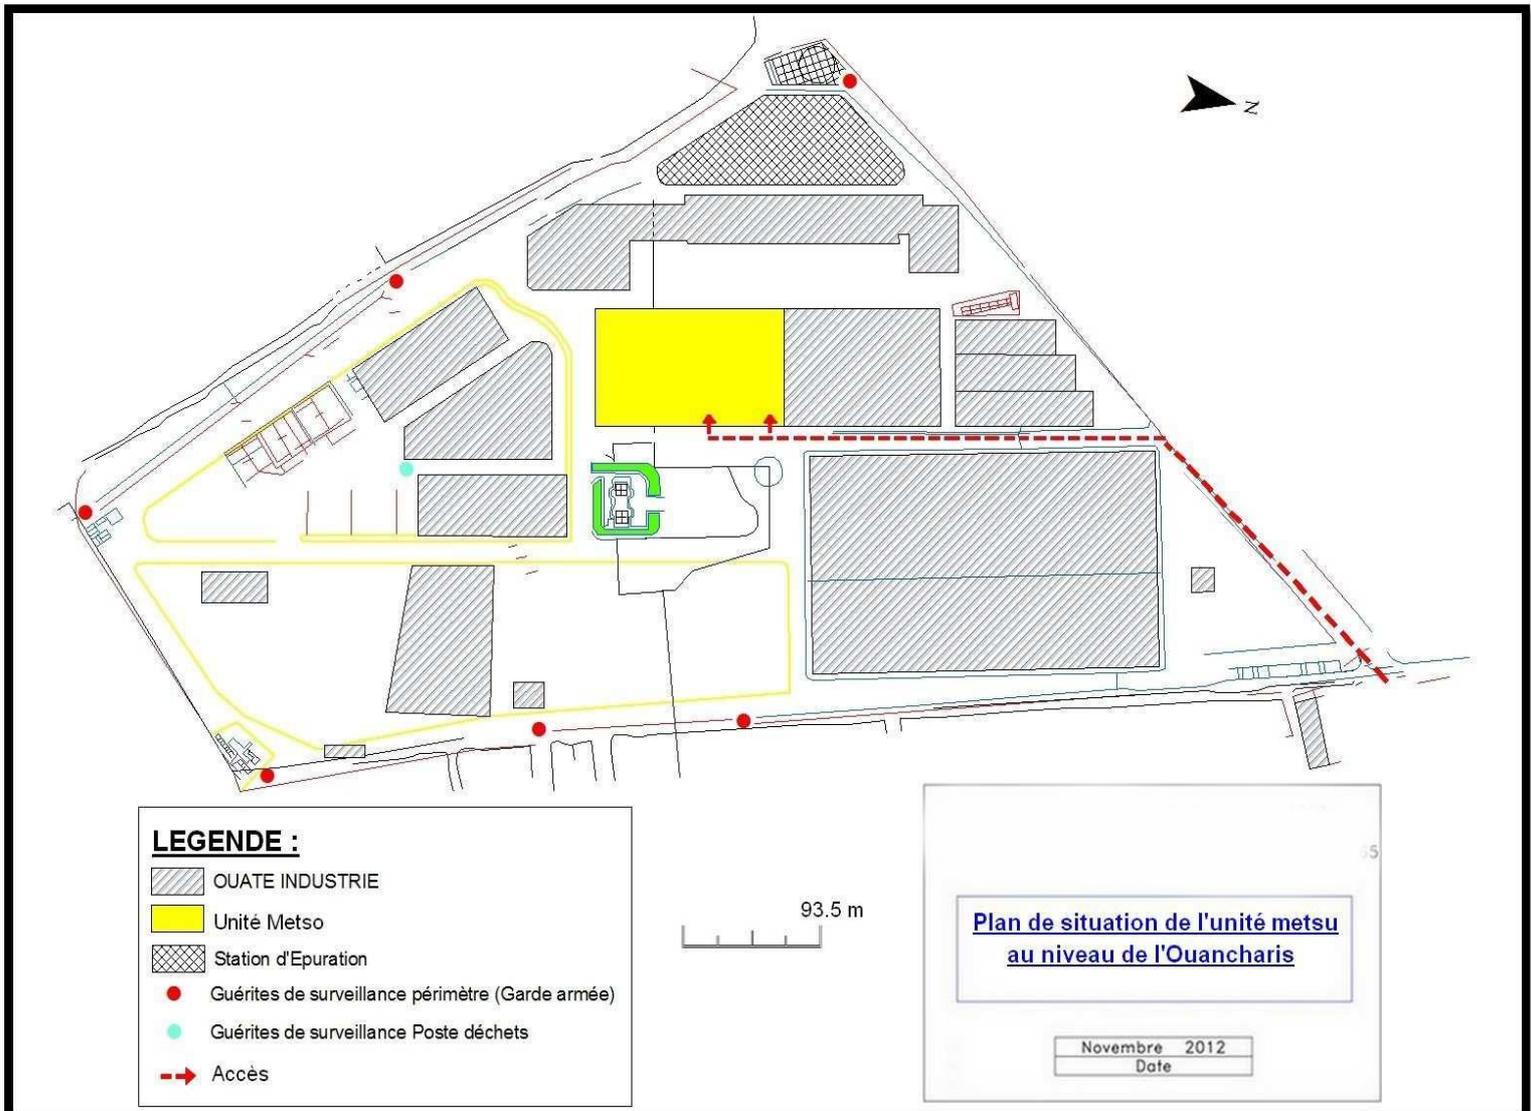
Plan d'accès à l'unité Metsu [3]
